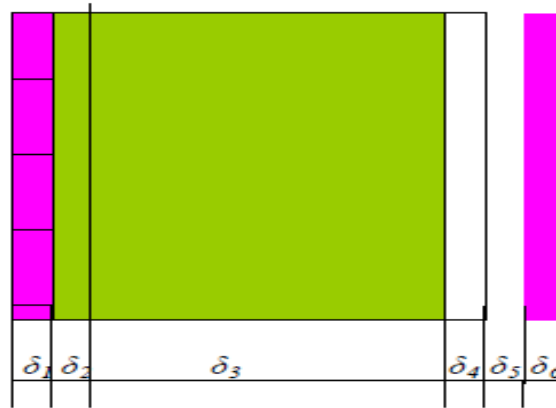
Схема поперечного перерізу зовнішньої стіни:
